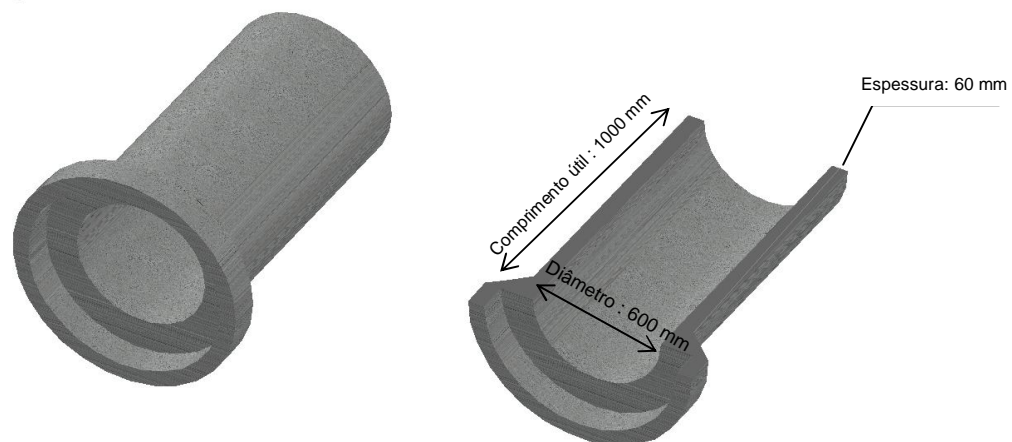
Tubo de concreto simples, armado ou com fibras de aço
